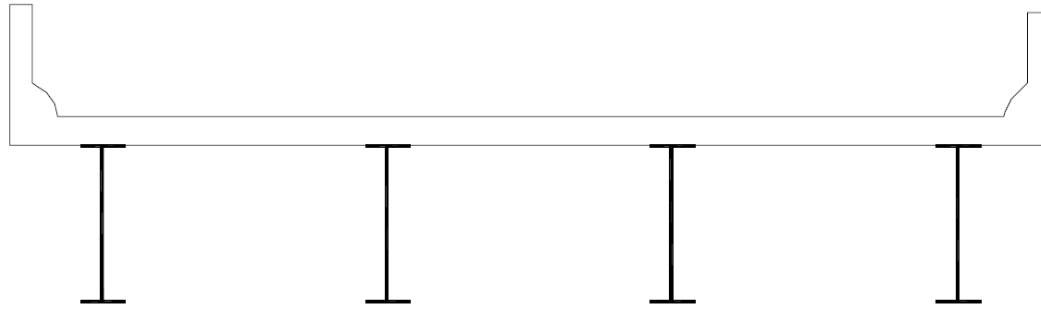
Sección transversal de puente con vigas de acero (AASHTO, 2007).
